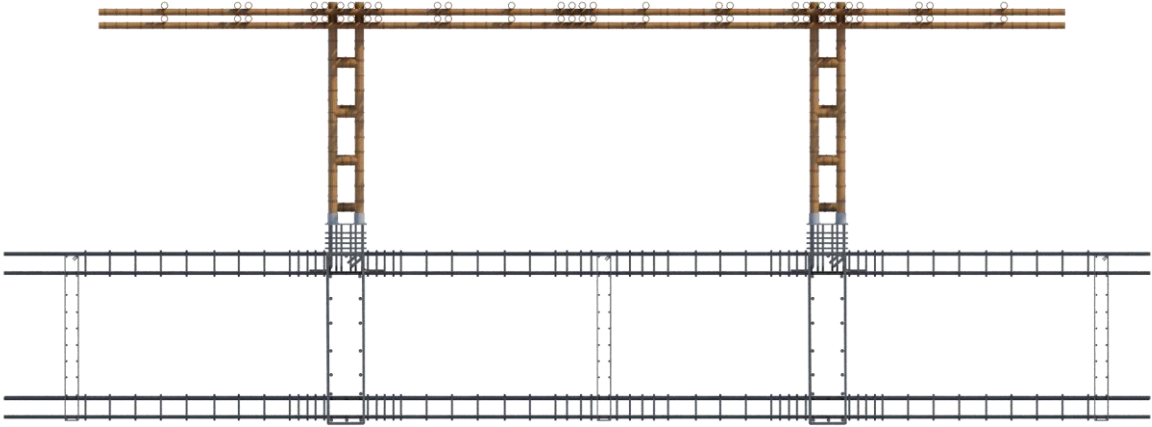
Detalle #1 placa flotante-columna-viga entre piso
